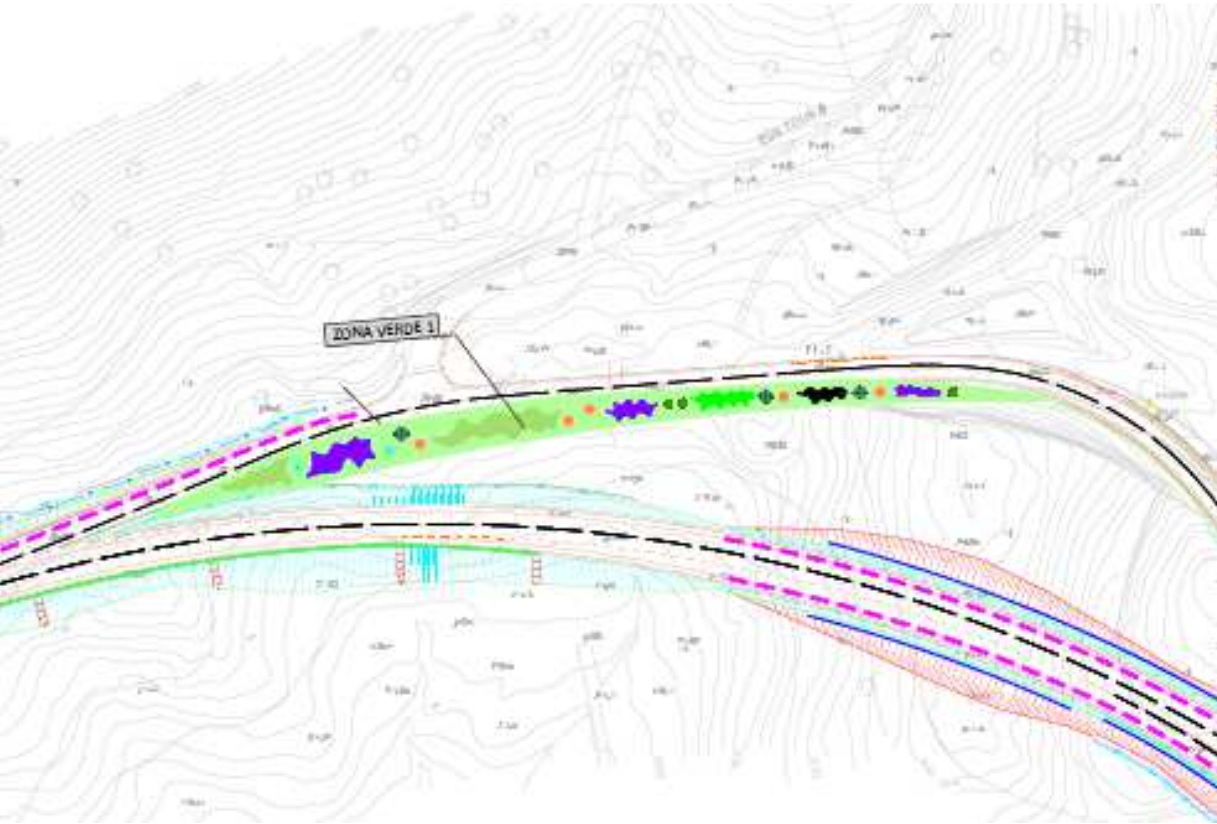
Zona 1 de revegetación. Fuente: Elaboración propia.
